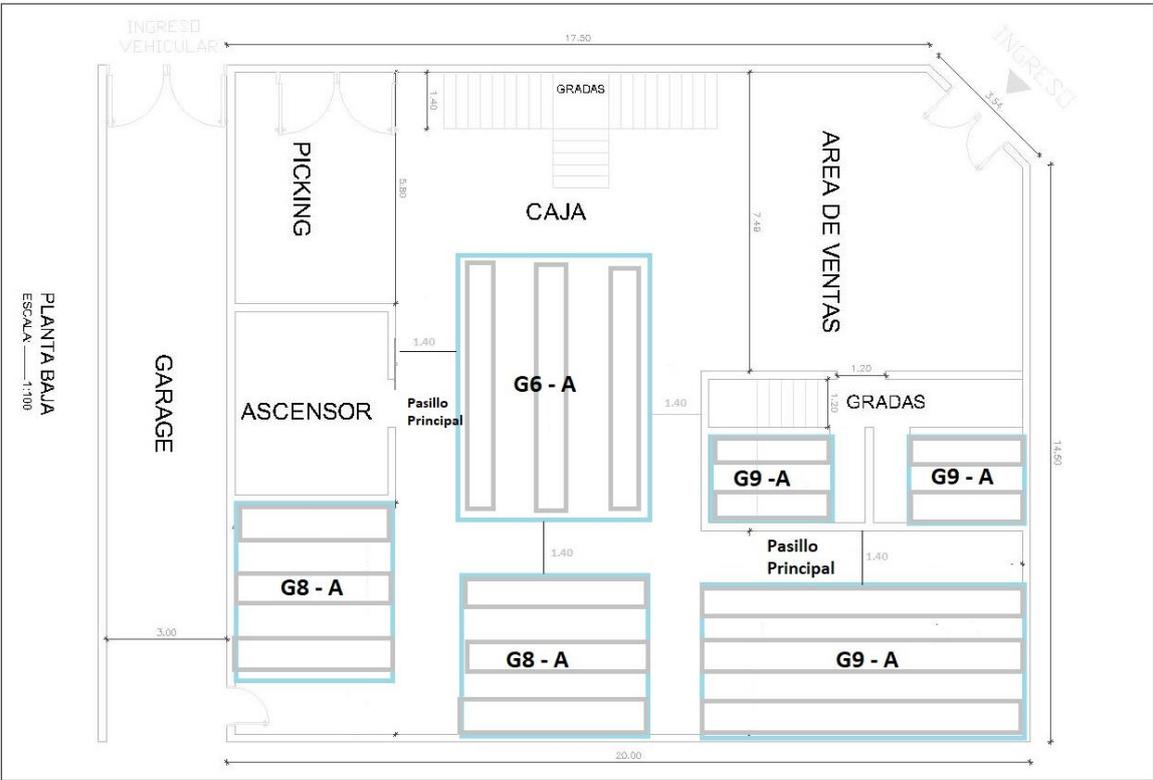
Propuesta de Distribución Planta Baja – Ingreso Principal
